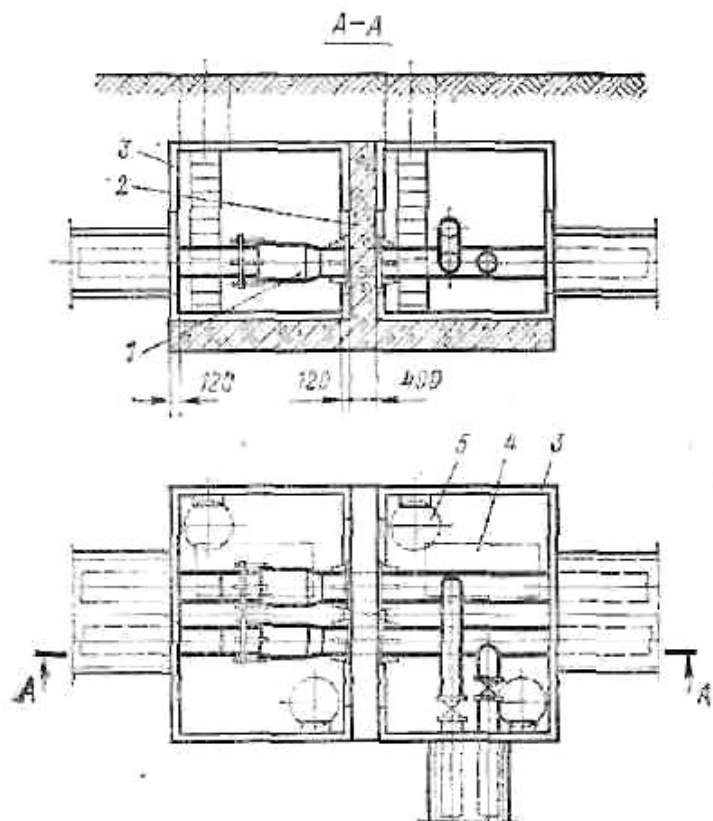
Камера из типовых вибропркатных плит с одним ответвлением:
